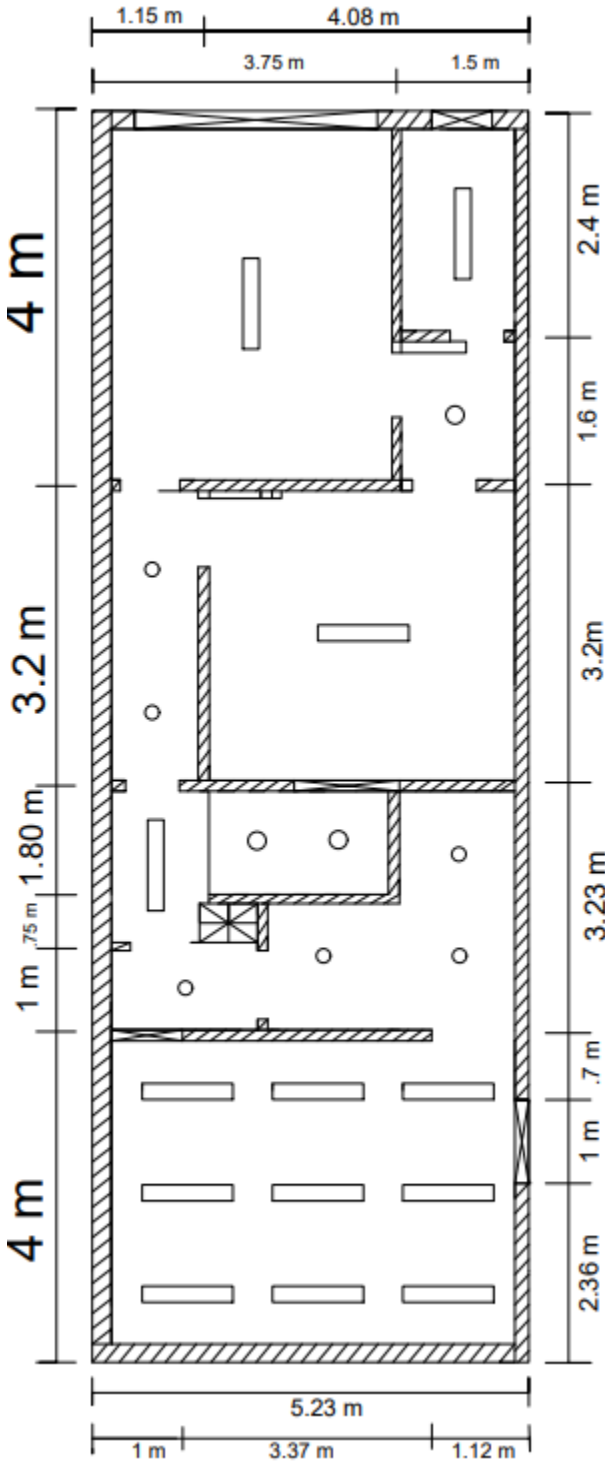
Plano de distribución de luminarias planta baja propuesta 3
